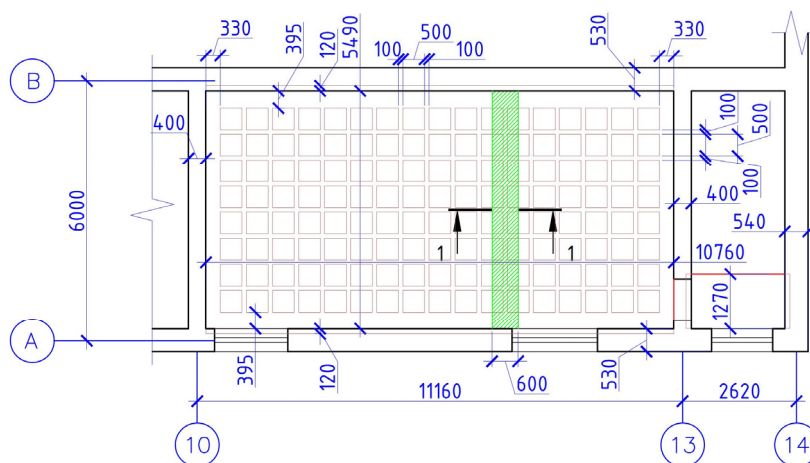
План 4-го варианта перекрытия – плиты 200 мм
